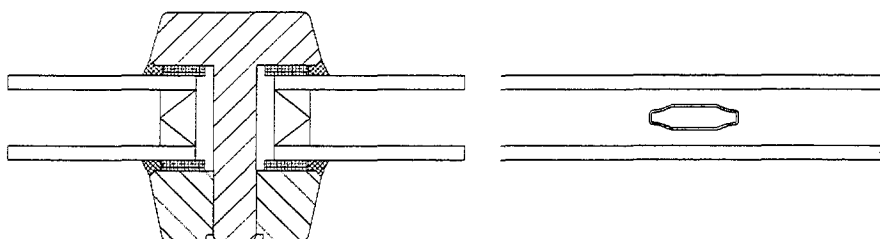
Querschnitte der geprüften Sprossenprofile des Holzfensters
